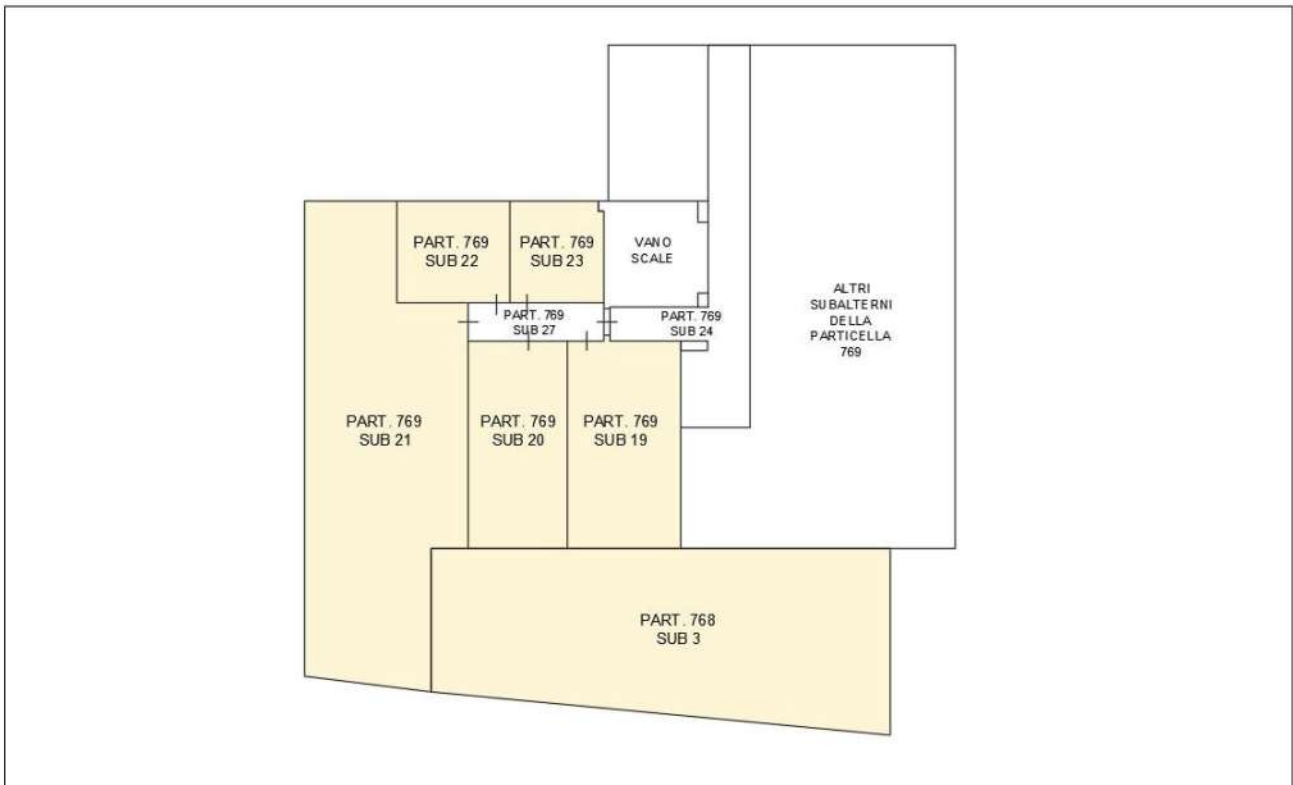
Planimetria con individuazione degli immobili oggetto di pignoramento
